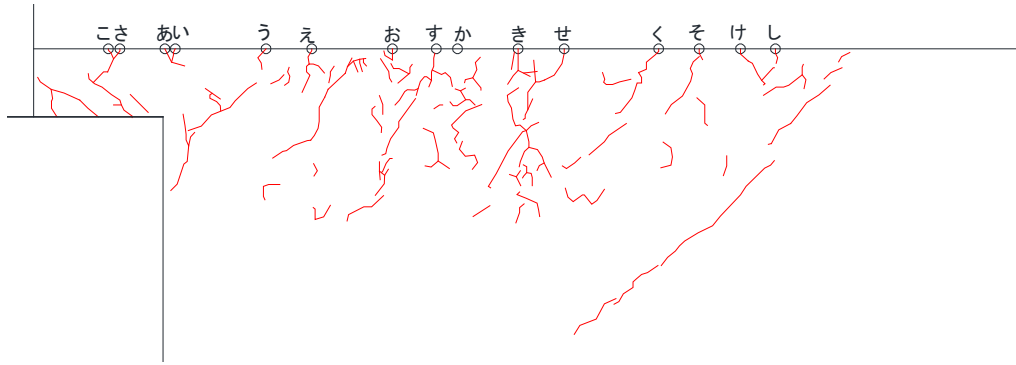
基礎梁ひび割れ幅測定位置(試験体 C-3 負荷荷)
